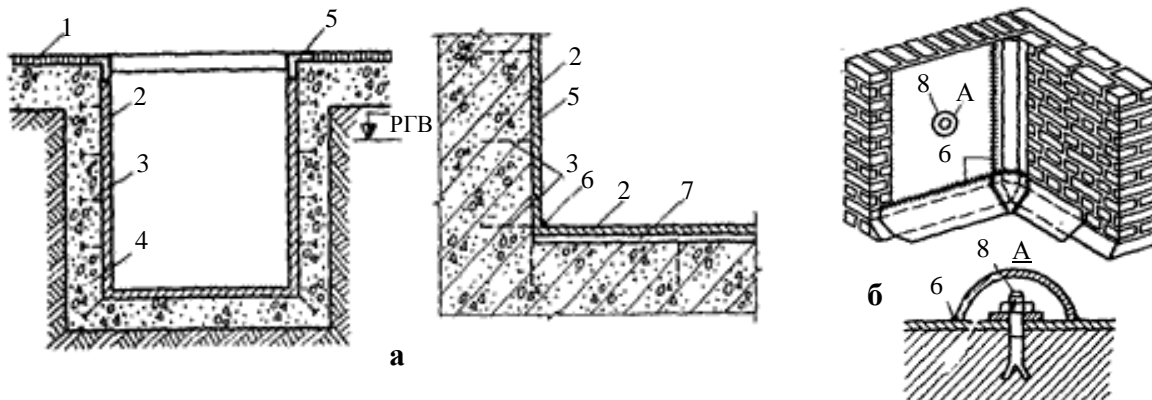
Схема влаштування листової ізоляції: а – сталевими листами; б – пластмасовими листами; 1 – підлога; 2 – сталеві листи; 3 – анкер; 4 – конструкція, що ізолюється; 5 – кутки; 6 – місце зварювання; 7 – цементний розчин; 8 – кріплення листів; РГВ – рівень ґрунтових вод
